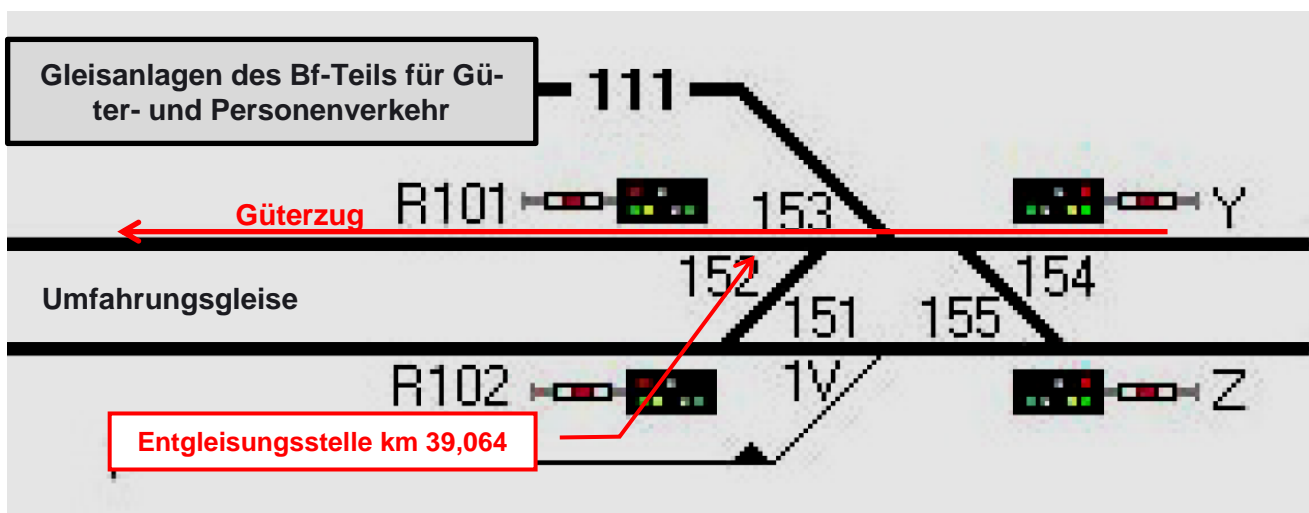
Lageplanskizze – Detailauszug IM-Bf (Quelle IM)
